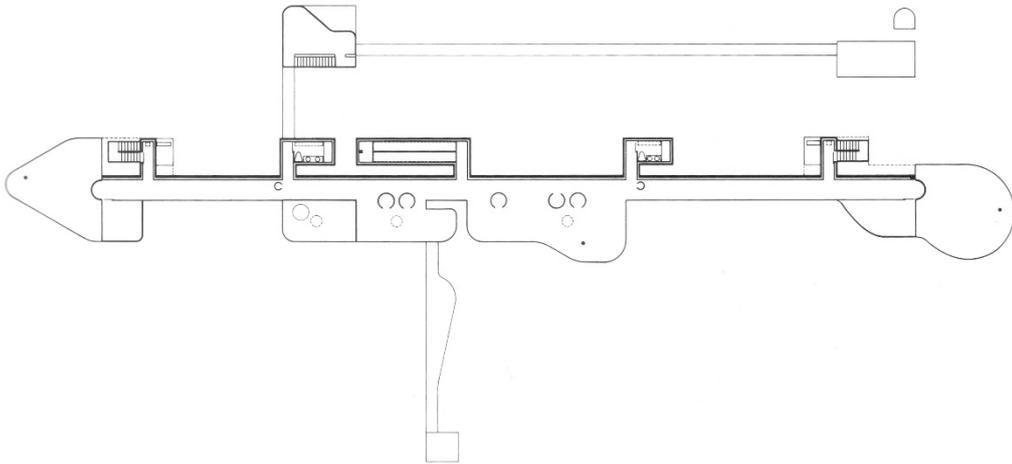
James Amatzuzo. *House* (1968-1969). Planta Baixa pav. inferior.
